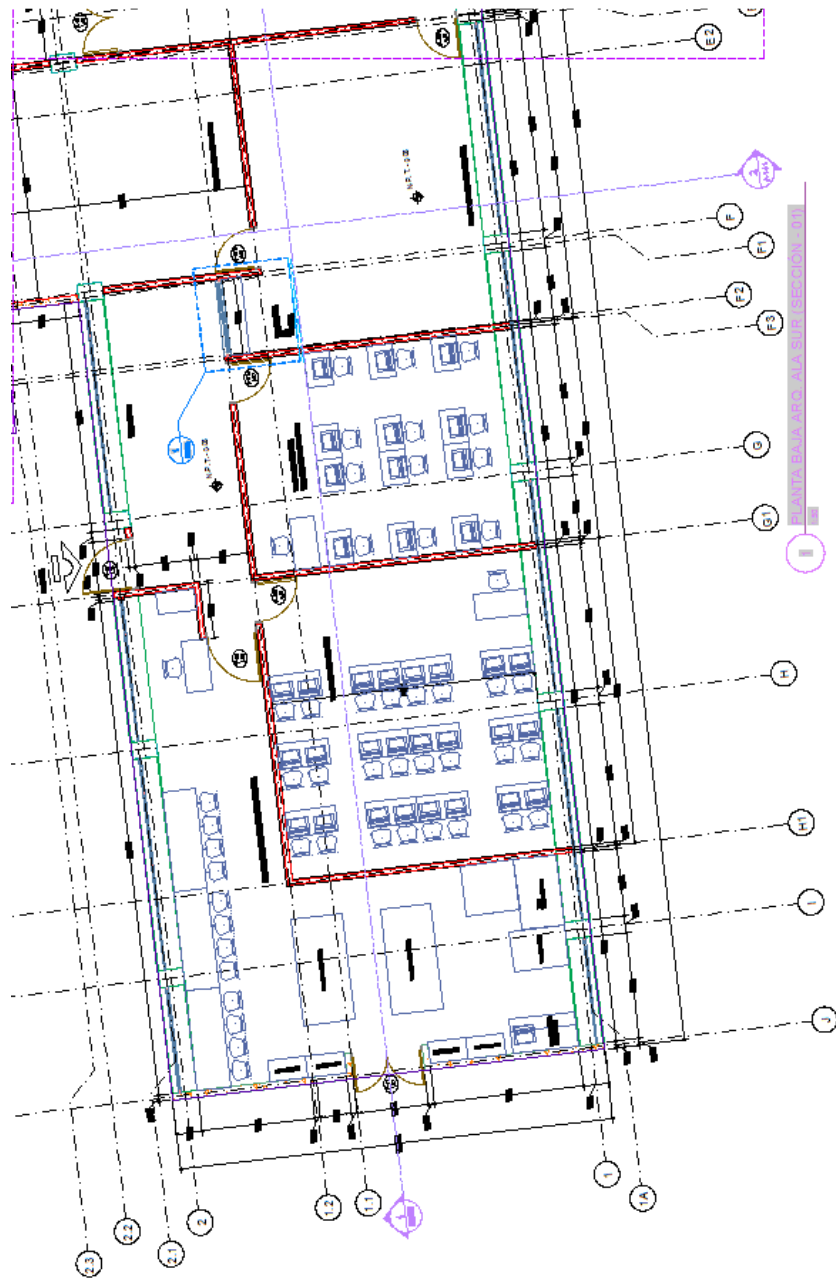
Planta Baja Ala Sur Sección 1 localizando detalle 1.
